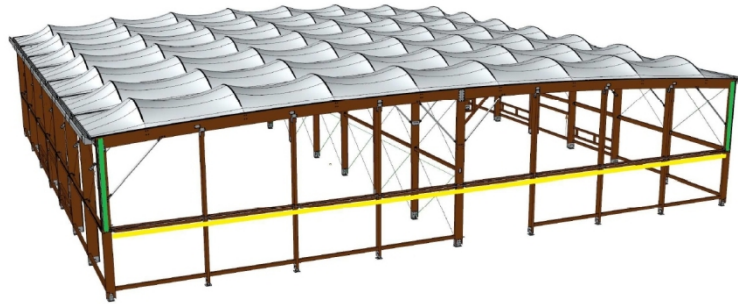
Façade textile plane pignon – repérage des types de fixation
